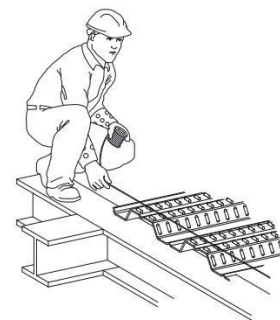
Detalle de colocación de lámina de losacero. Fuente: Manual de instalación Ternium losacero,
